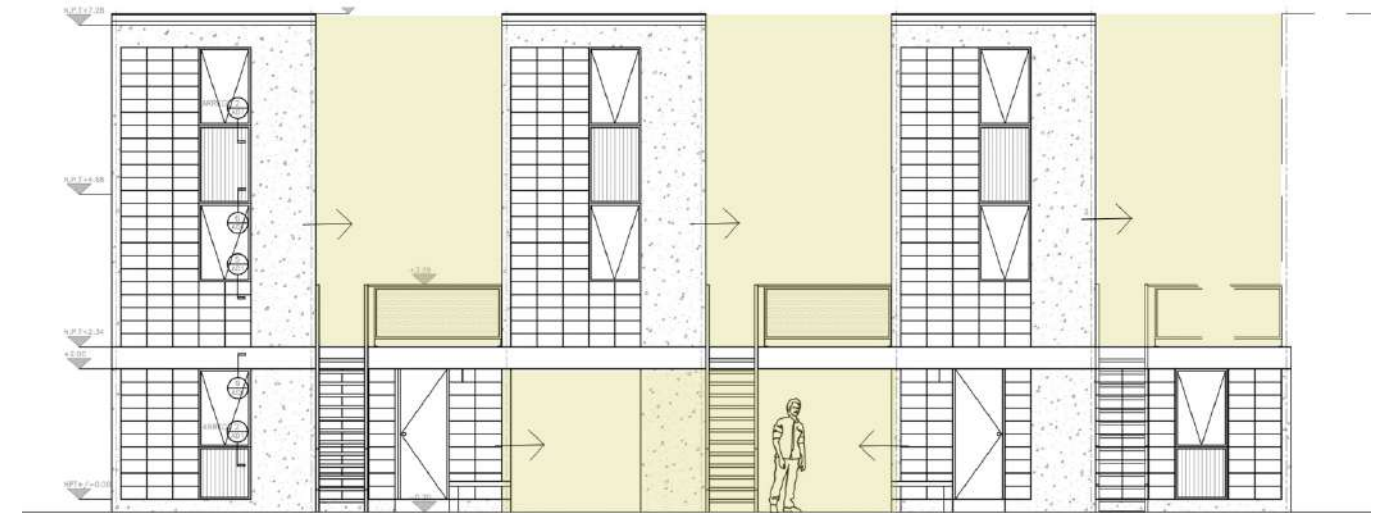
Elevação frontal. Fonte: archdaily. Editado pela autora.
